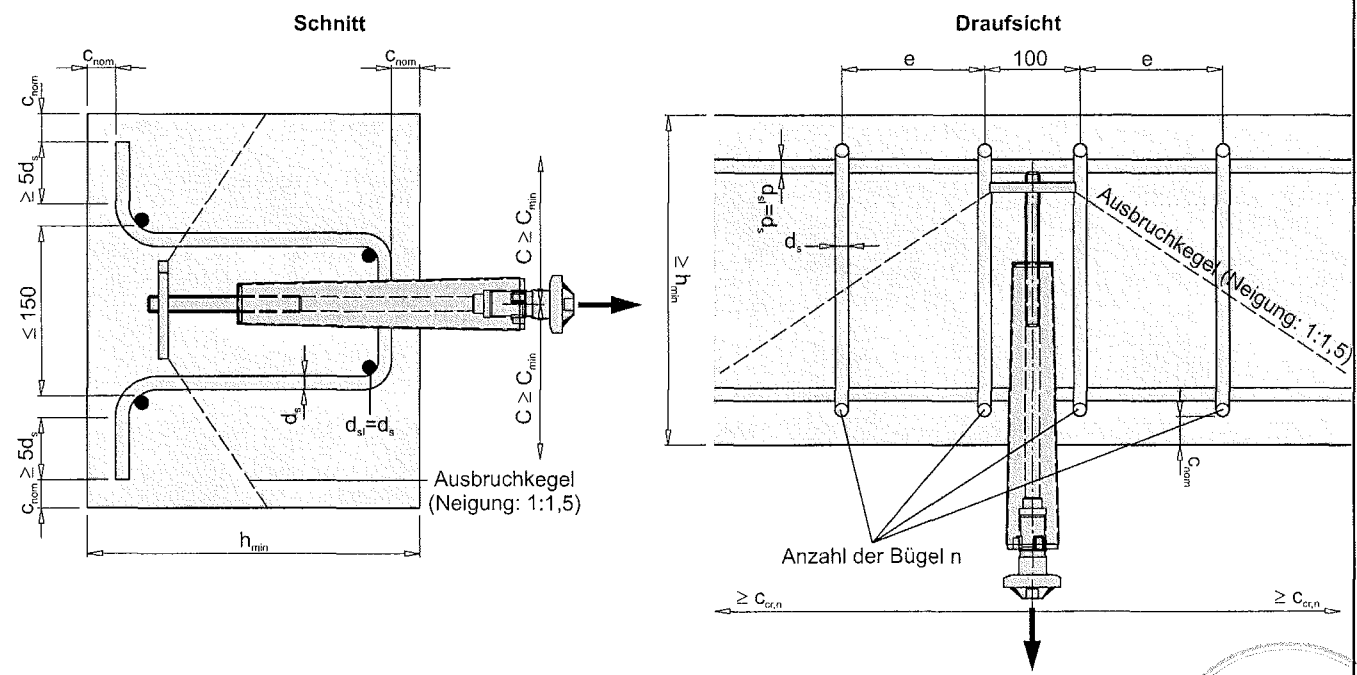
Einbausituation in dünne Wände - Zugbeanspruchung mit Rückhängebewehrung - Bewehrungslage
